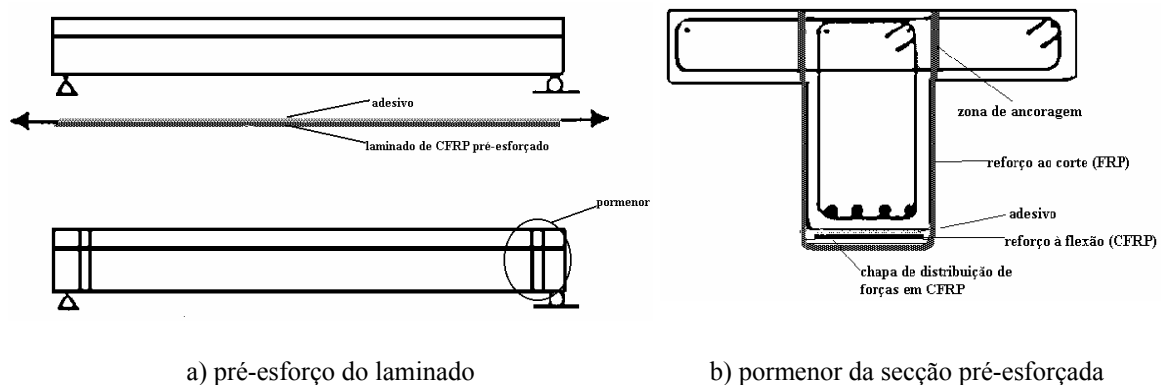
Reforço de um viga com um laminado pré-esforçado e sistema de ancoragem.
